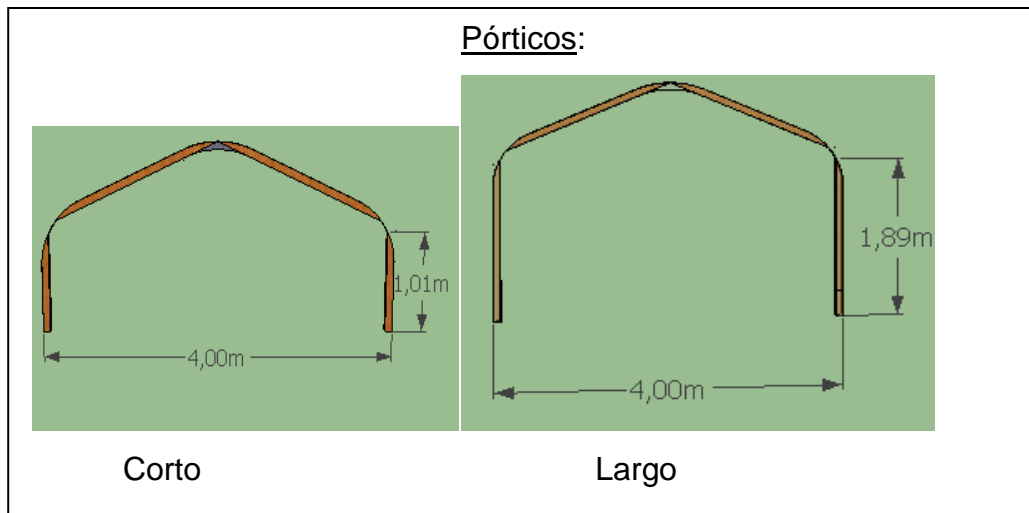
Detalle de los pórticos de la estructura cubierta
